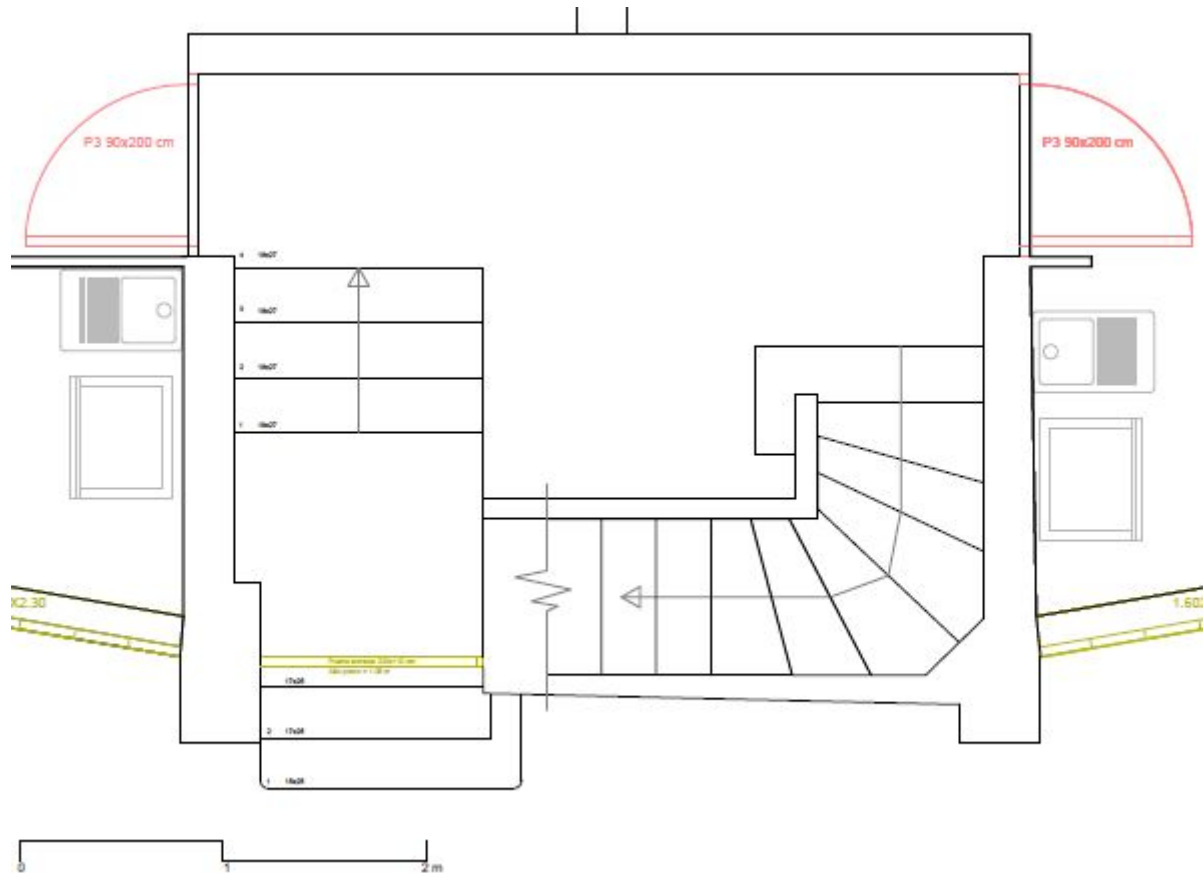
Planta entrada, BH E5 (Fuente: Anejo A)
